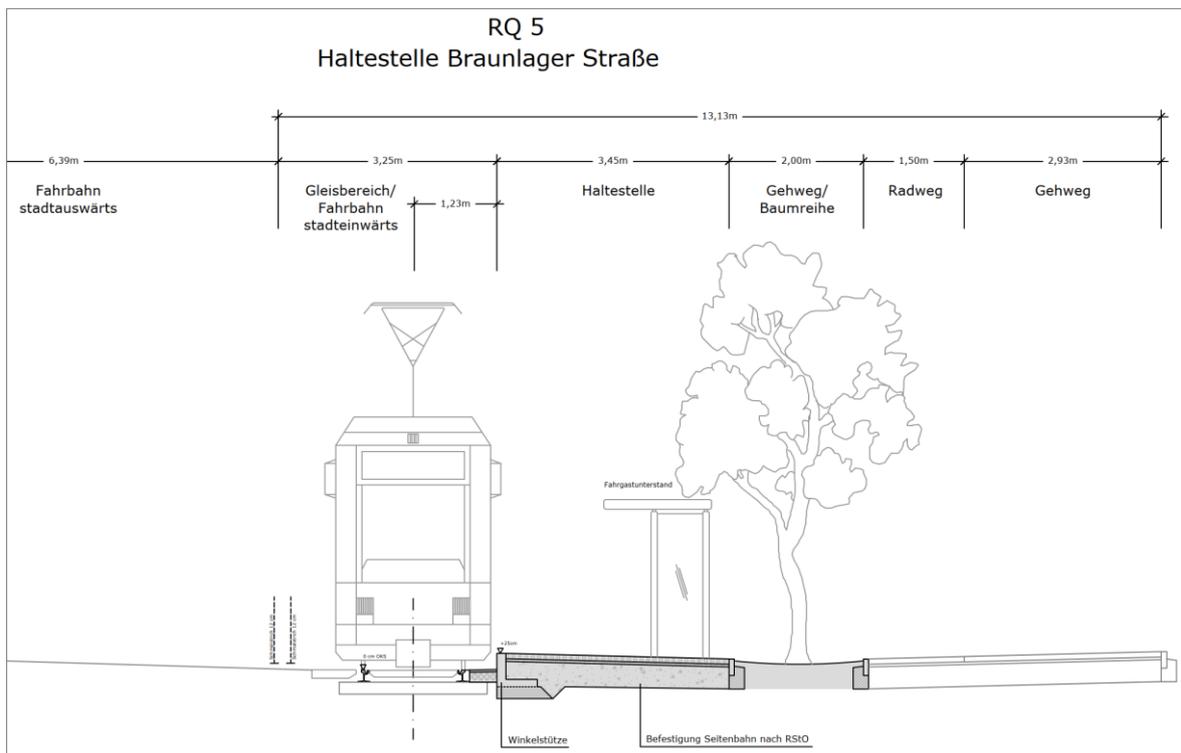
Querschnitt RQ5 – Haltestelle Braunlager Straße stadteinwärts
